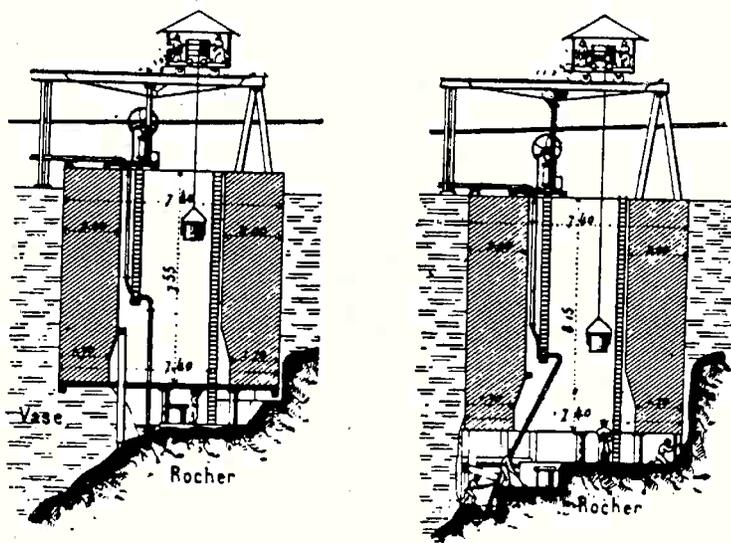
Fundação em poços dos pilares da muralha de Saint Nazaire.
